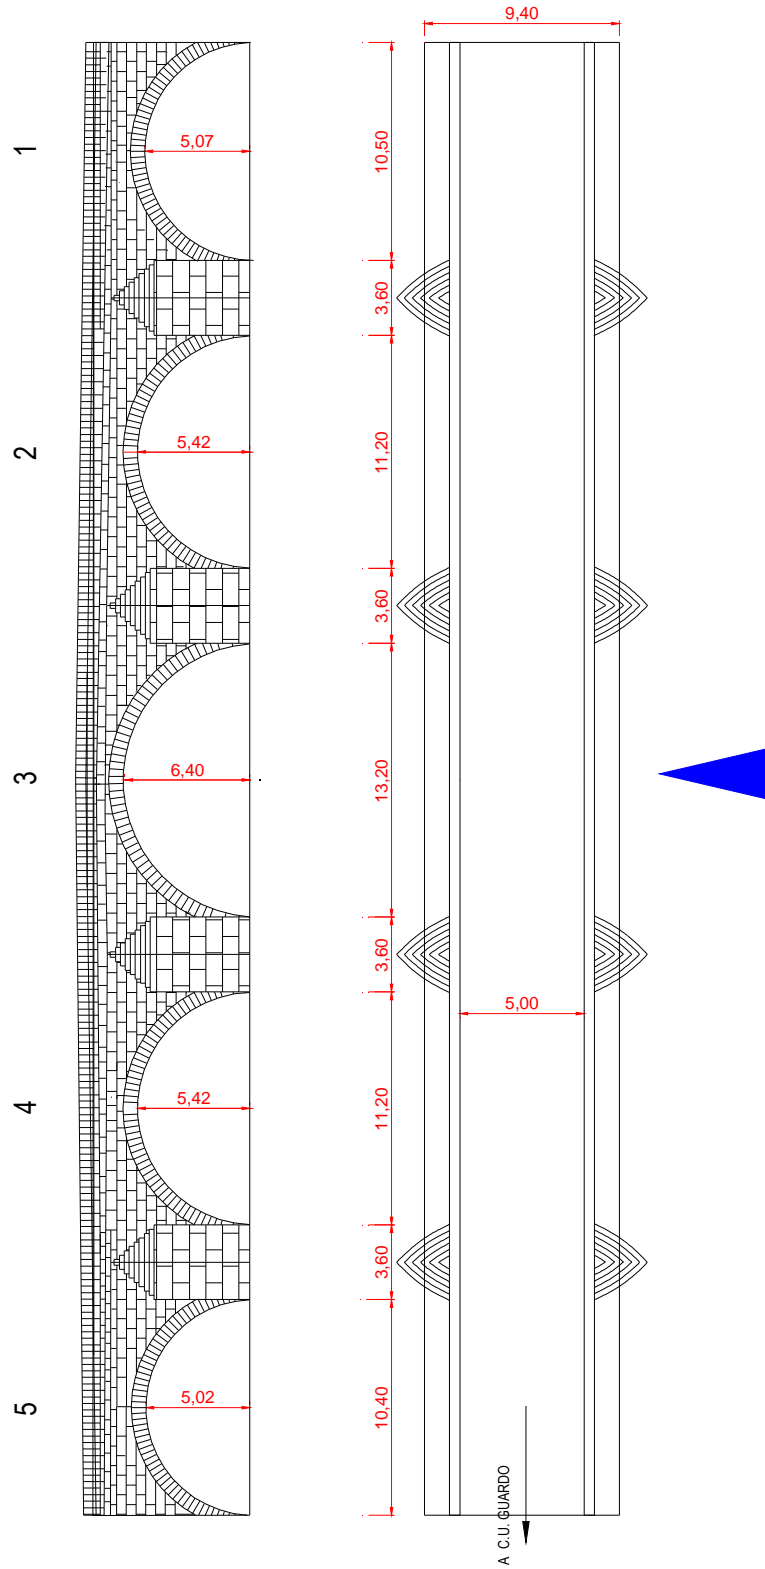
Planta y alzado de aguas abajo del puente en Guardo
